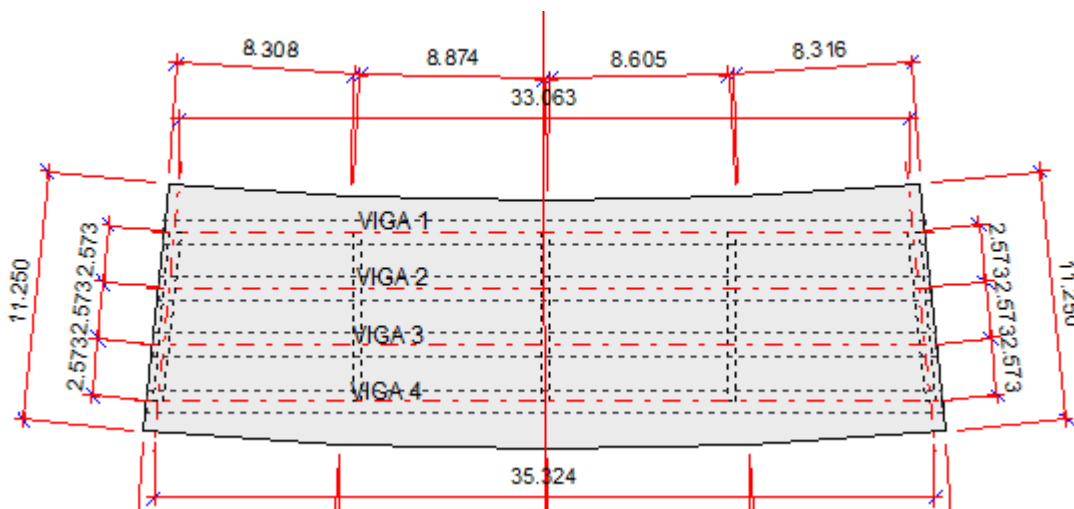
Planta de estructura. Fuente: IDOM-DEHC.
